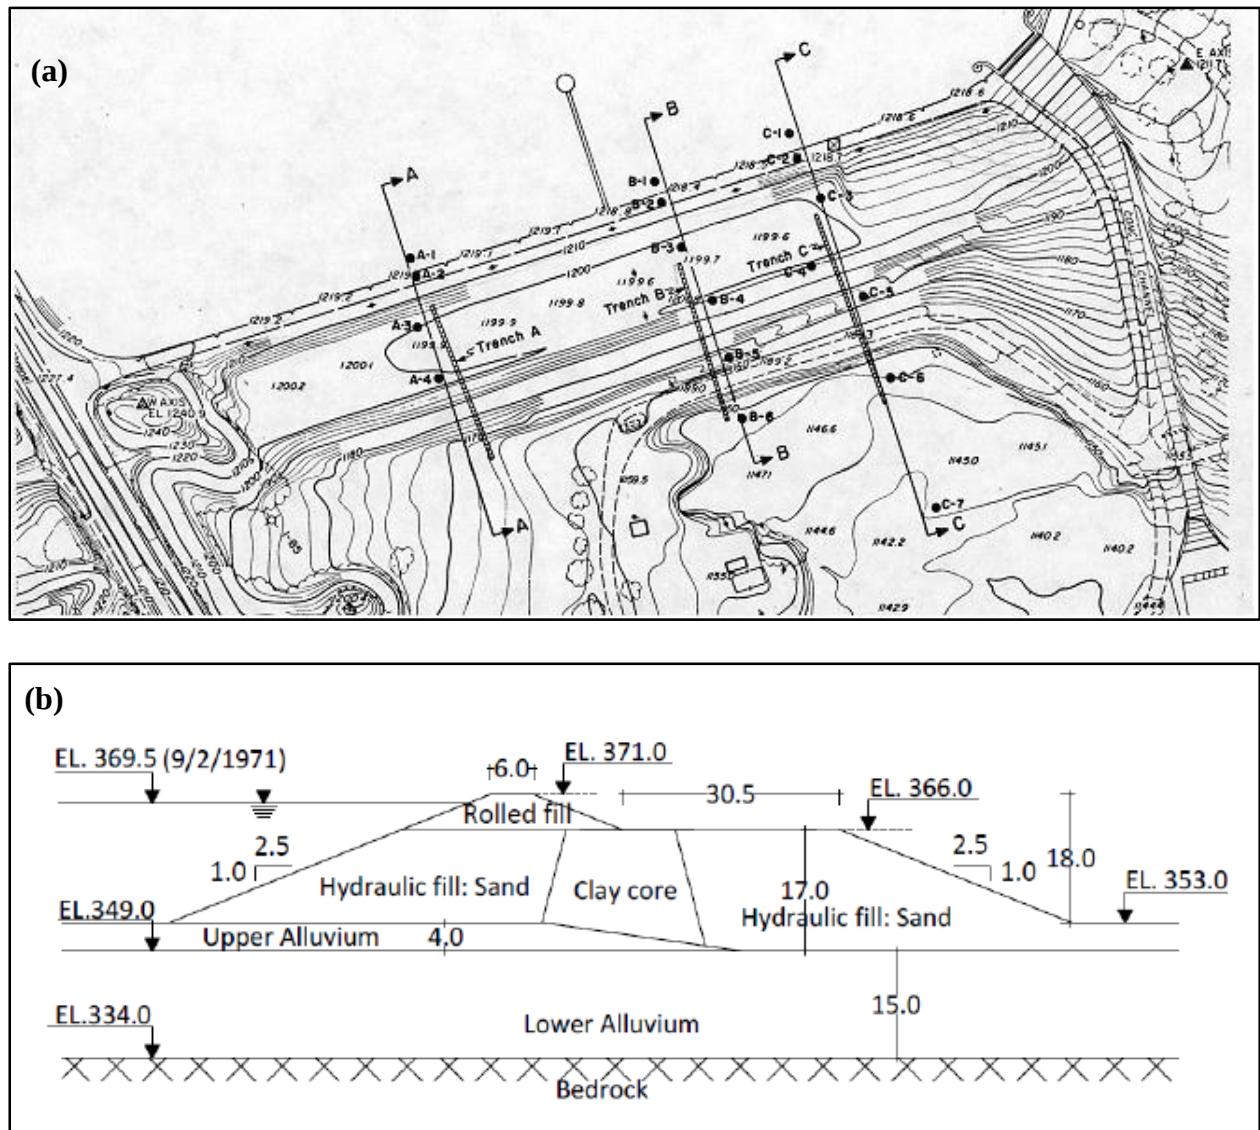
(a) Vue en plan du barrage Upper San Fernando (Extrait de Huynh et al. 2006) ; (b) Coupe typique- Section B-B' (Seed et al., 1973).
